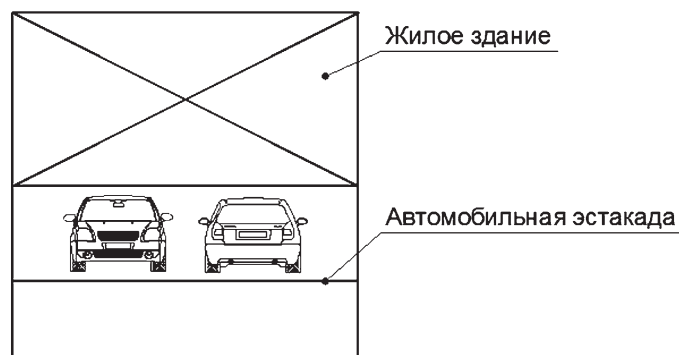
Схема размещения малоэтажных зданий на эстакаде
